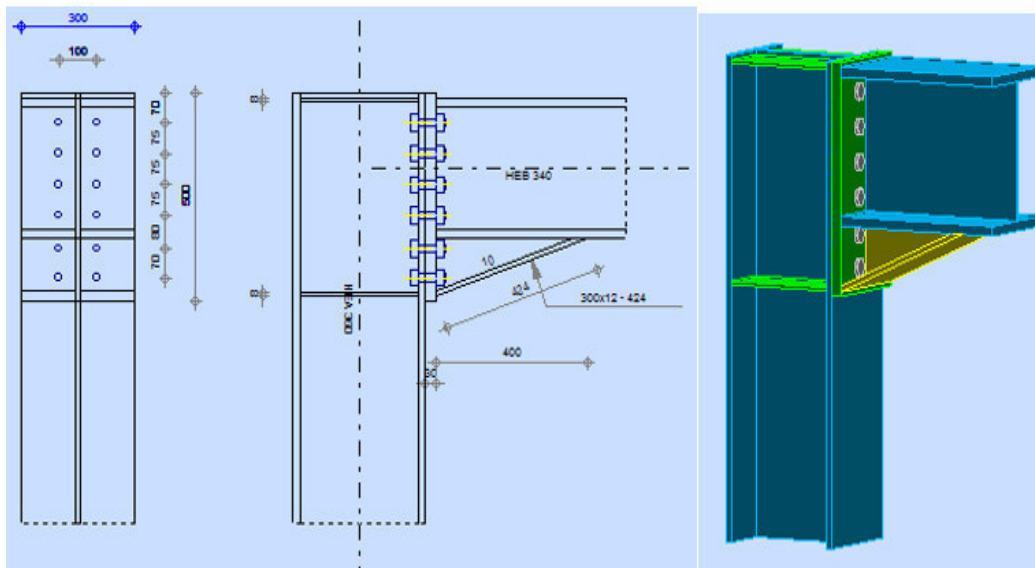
Représentation de l'assemblage poteau - poutre maitresse.
